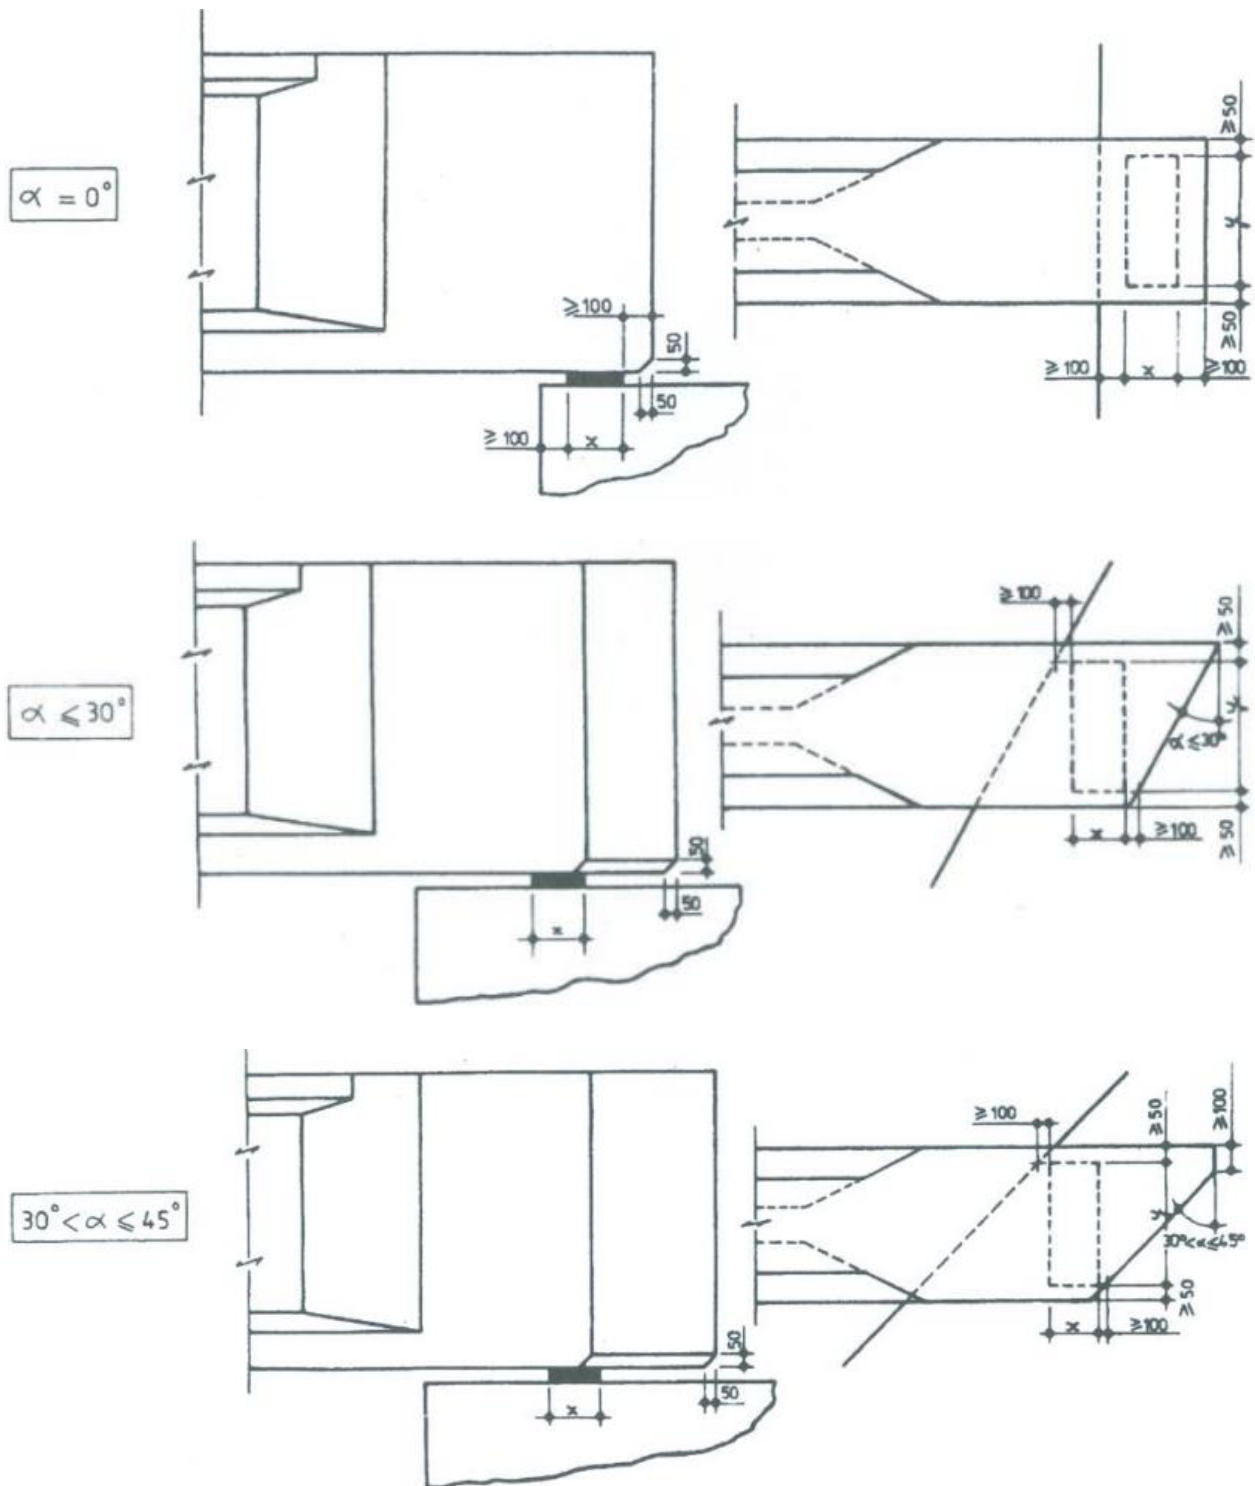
Disposições construtivas da viga e do aparelho de apoio na região do apoio para vigas com extremidade normal. Fonte: FIB 2004.
